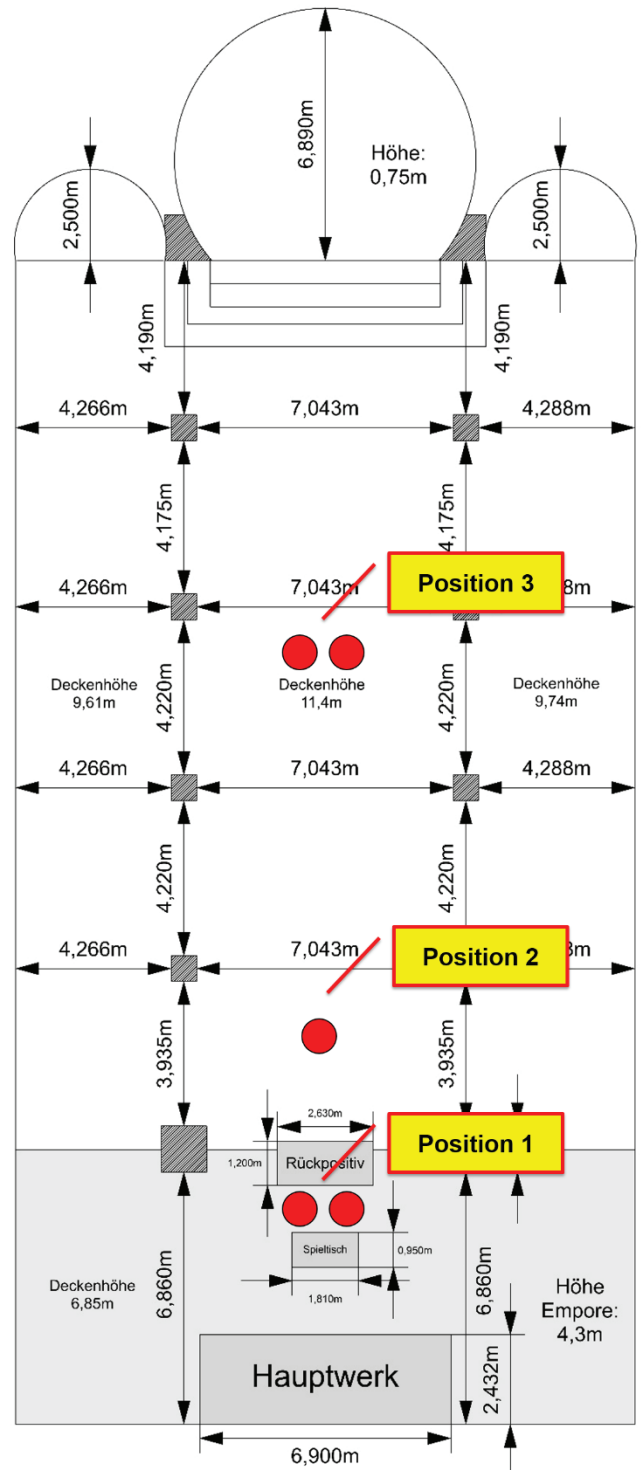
Grundriss der Kirche und Mikrofonpositionen.
